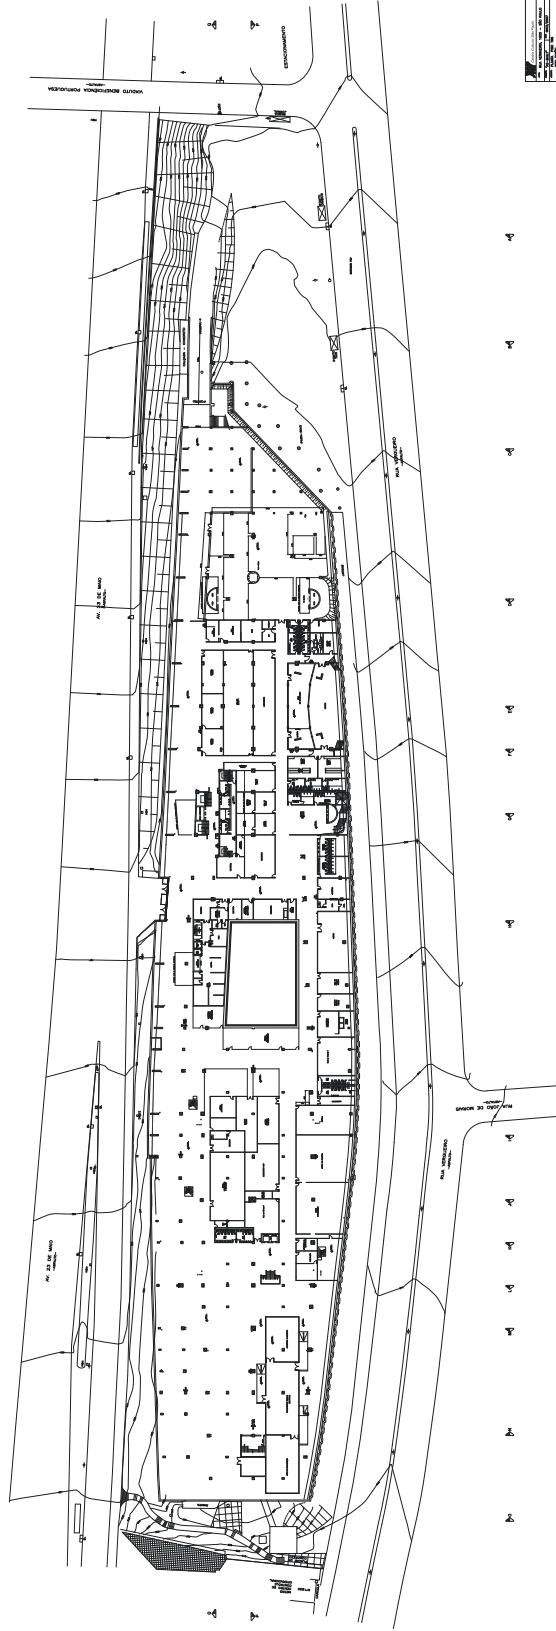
Grundriss 2. Untergeschoss
